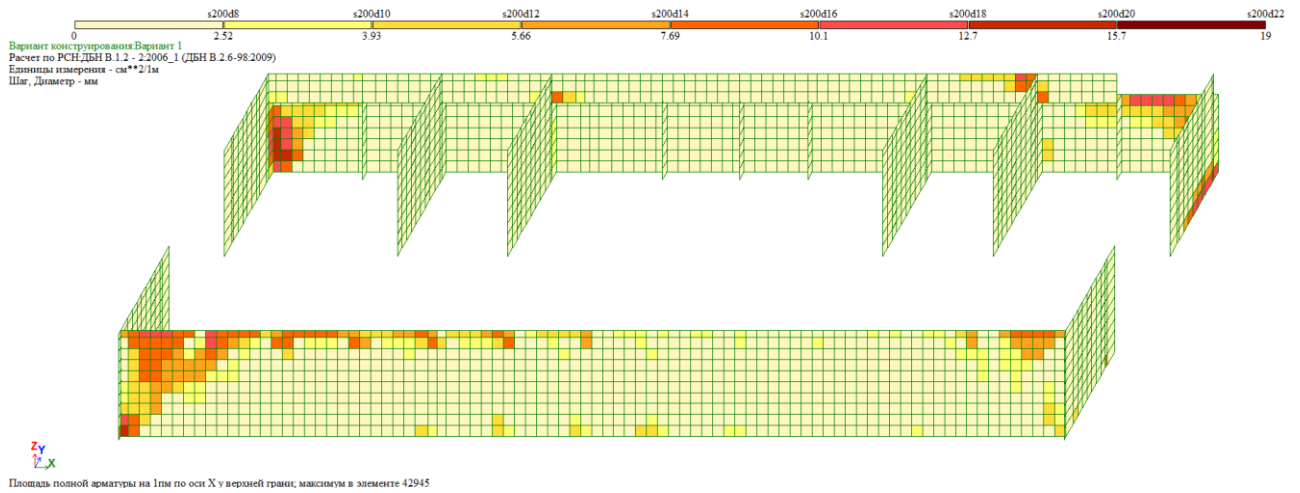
Розрахункове армування верхньої грані стін підвального поверху
